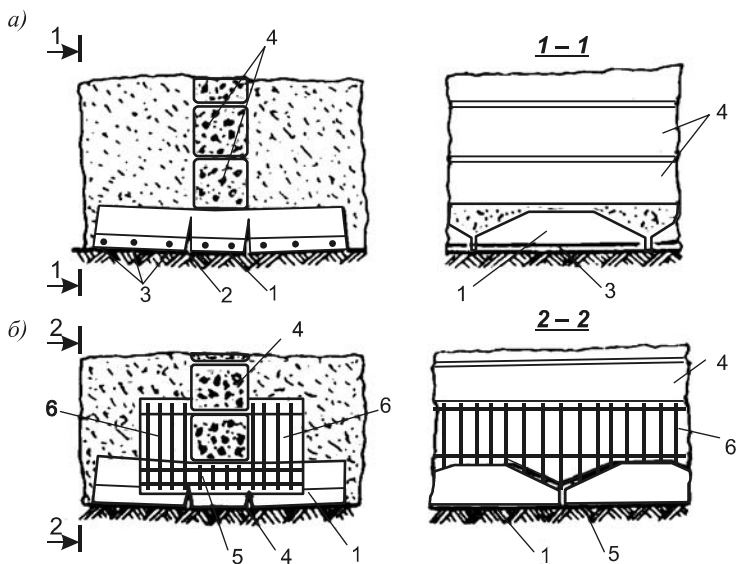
Схемы разрушения фундаментов из-за неправильной укладки железобетонных подушек (а) и конструкции усиления (б):
